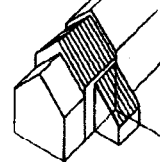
bâtiment secondaire en appentis au mur gouttereau
